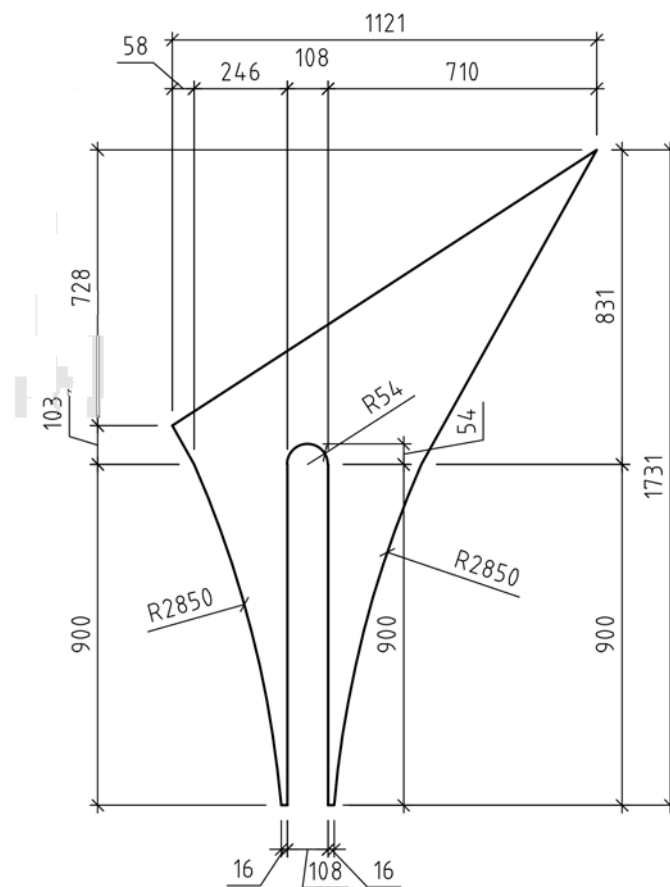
Knotenbleche vom geschweißten Hänger 3a01
